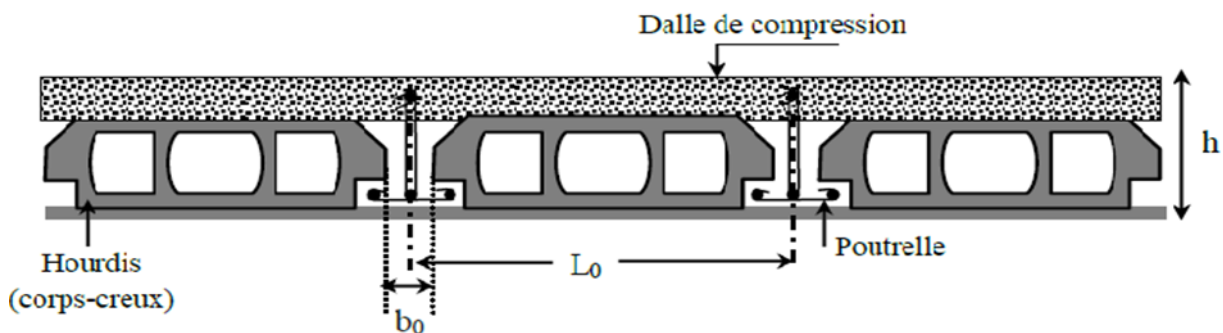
Coupe transversale sur un plancher à corps creux.
